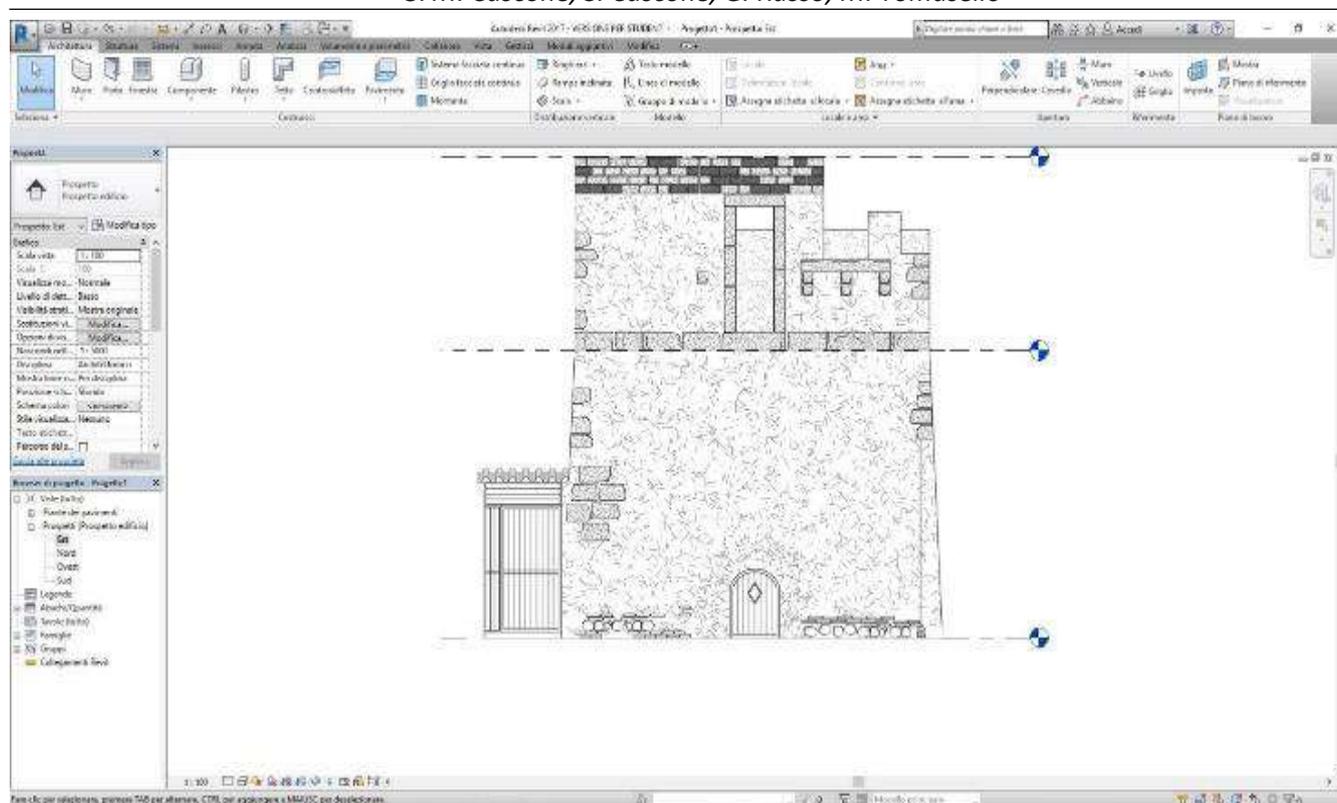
Prospetto ovest ricavato con Autodesk Revit Architecture 2017
